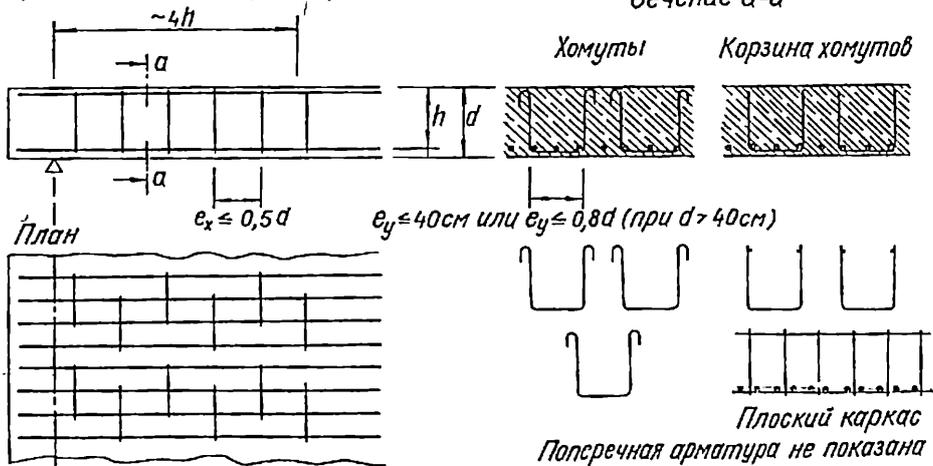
13. Расположение в плитах арматуры, работающей на скалывание
